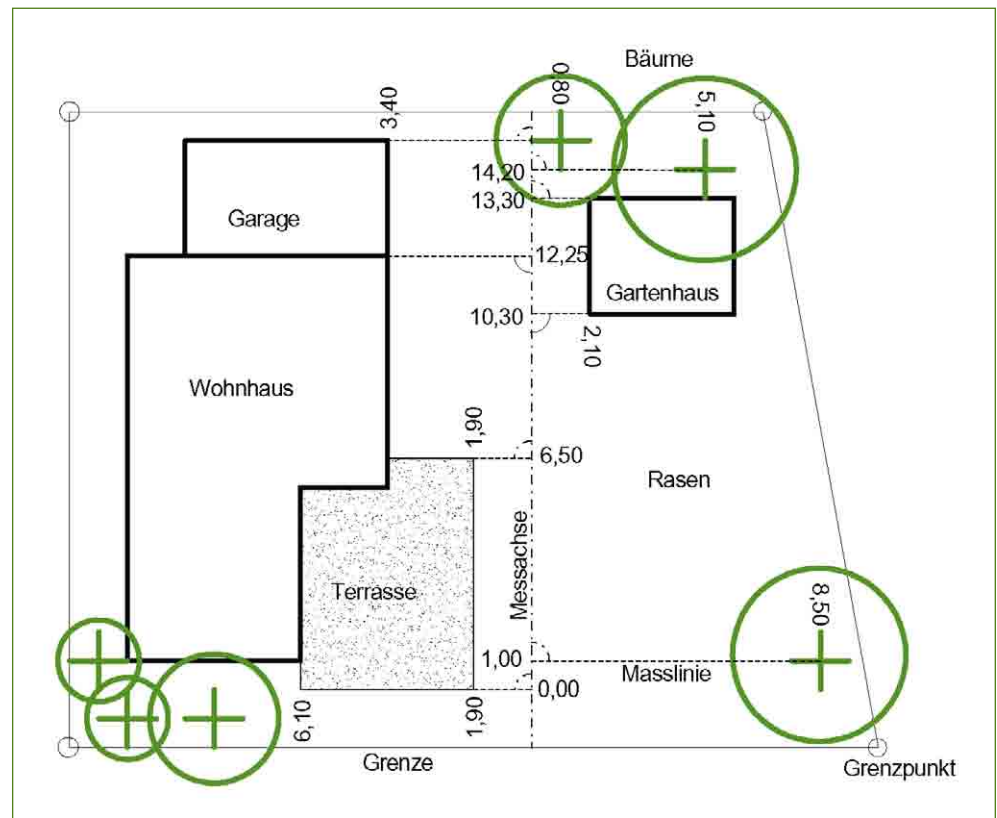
Plangrundlage als Beispiel, Aufnahme und Einzeichnen der Gartenelemente.
